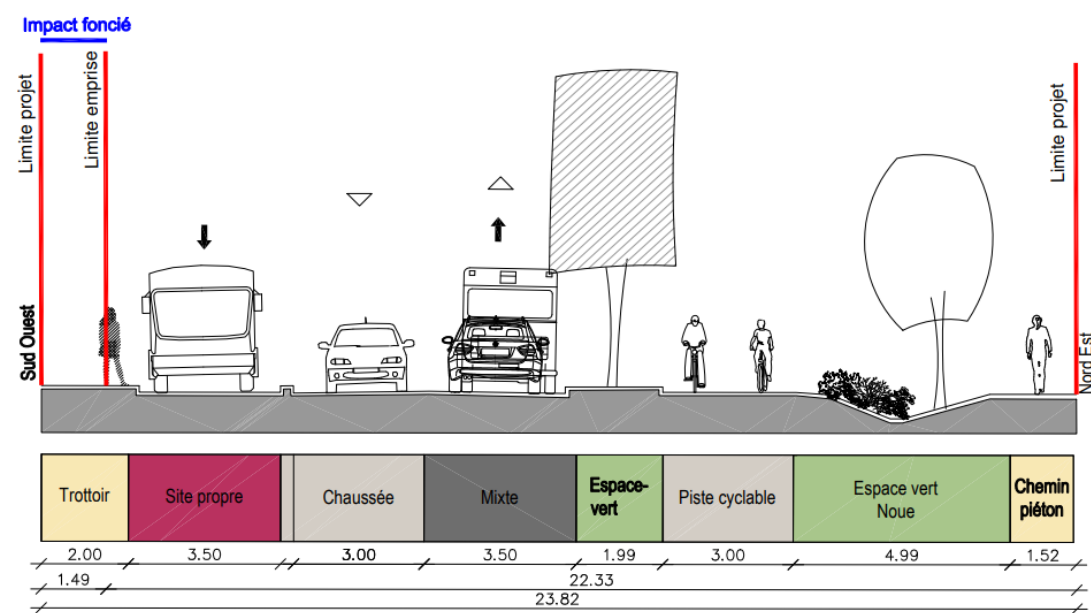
Coupe type en section courante sur le boulevard du Paris
